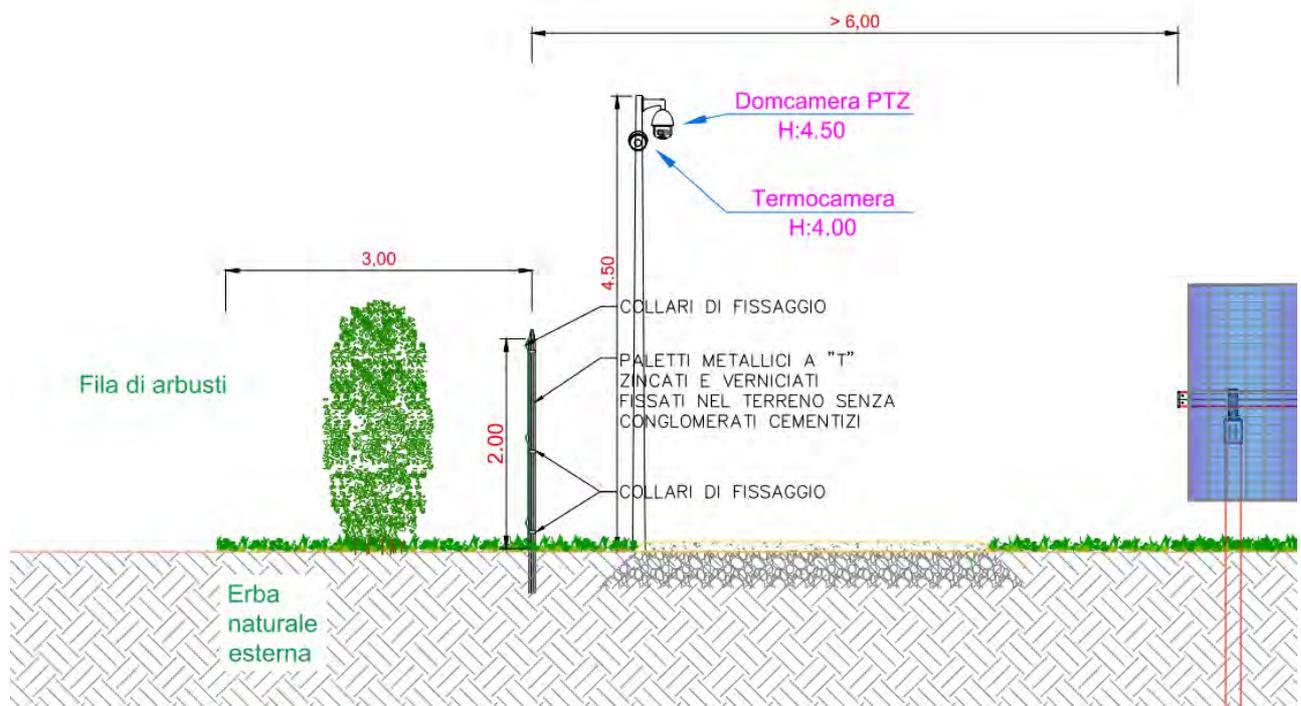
Sezione fascia arborea perimetrale esterna alla recinzione – 3 m
